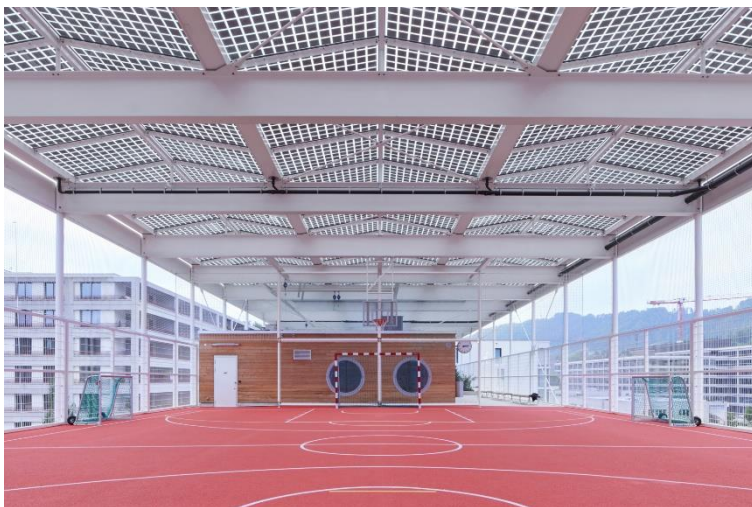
Auf dem Dach gibt es einen öffentlich zugänglichen Sportplatz, geschützt mit PV-Elementen.
